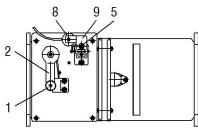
Seitenansicht BKA-EN (Handauslösung und Magnet)
